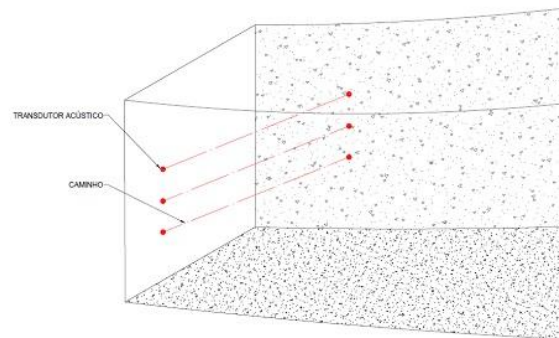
Detalhamento de uma das duas seções de saída do tubo de sucção. Fonte: Elaboração própria
